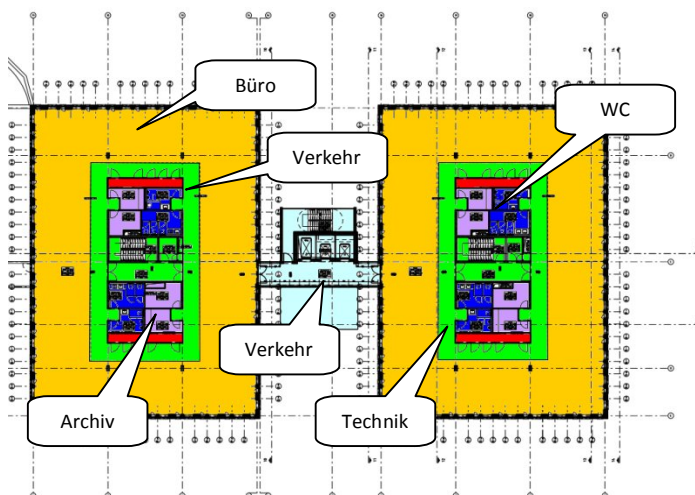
Grundriss Regelgeschoss mit Zonierung, Geb.5⁴
